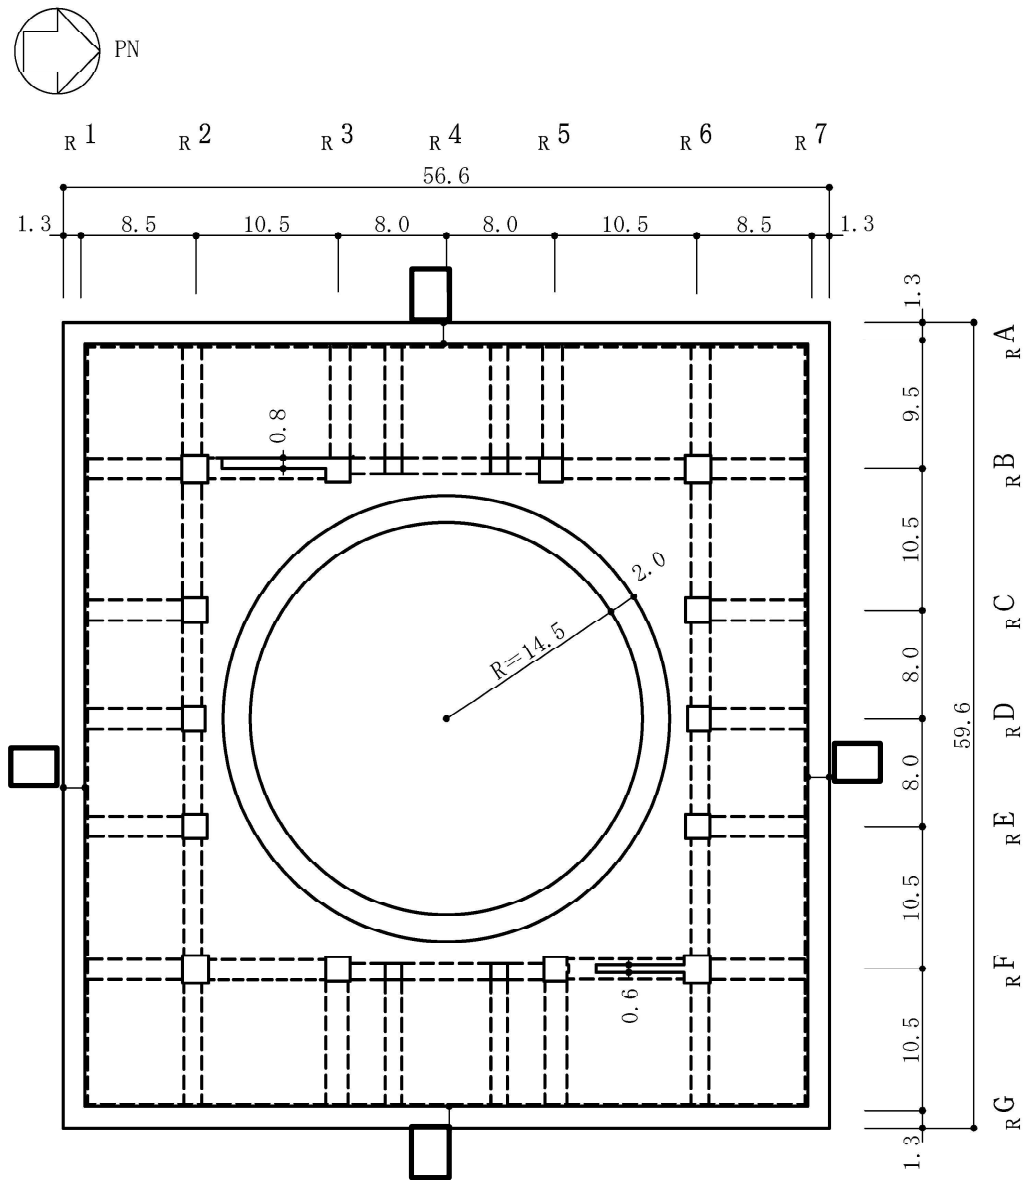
原子炉建屋の概略平面図 (B2F, T. M. S. L. -1.7m) (2/9) (単位 : m)
